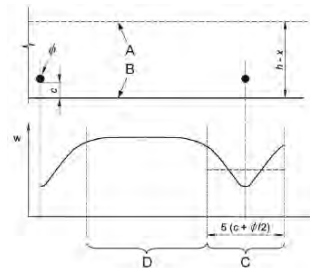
Ampiezza delle fessure, w, in funzione della posizione rispetto alle barre di armatura
